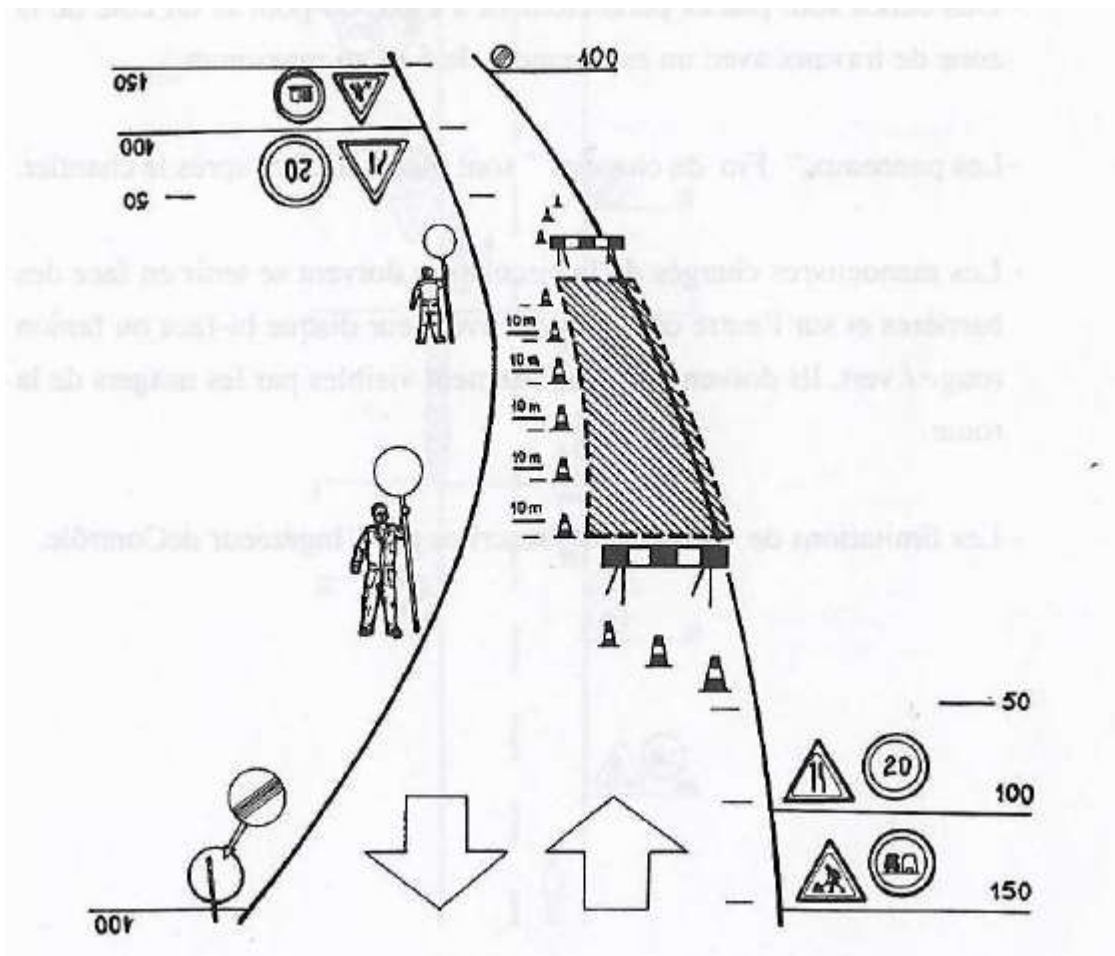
Plan de gestion de trafic pour les travaux en demi-chaussée des voies carrossables
